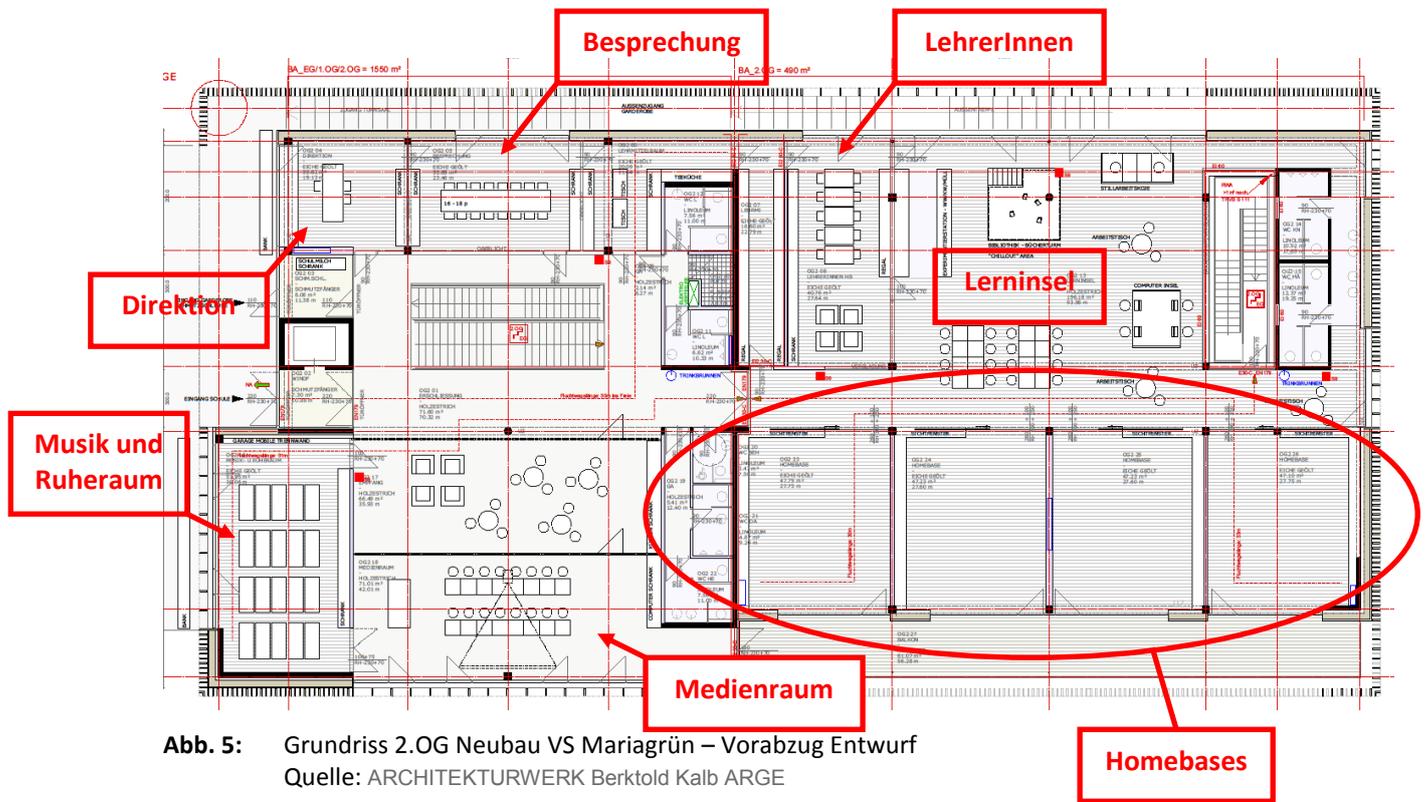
Grundriss 2.OG Neubau VS Mariagrün – Vorabzug Entwurf
